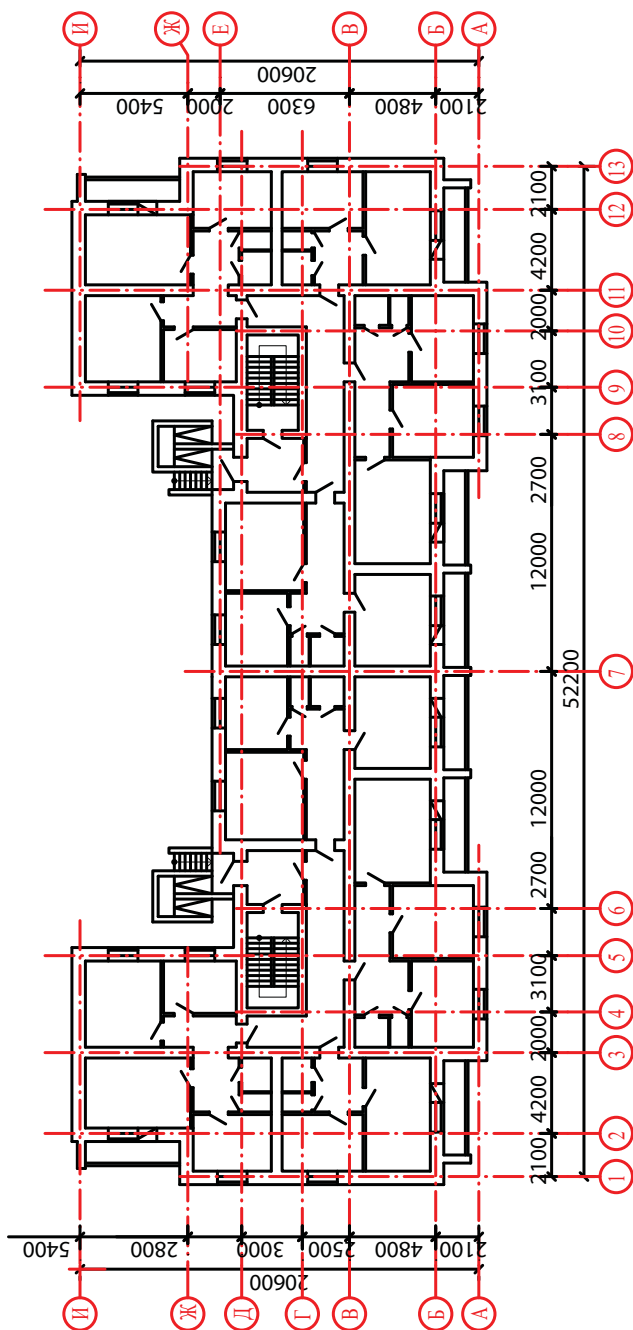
а План стен 1-го этажа пятиэтажного жилого дома в г. Бронницы
